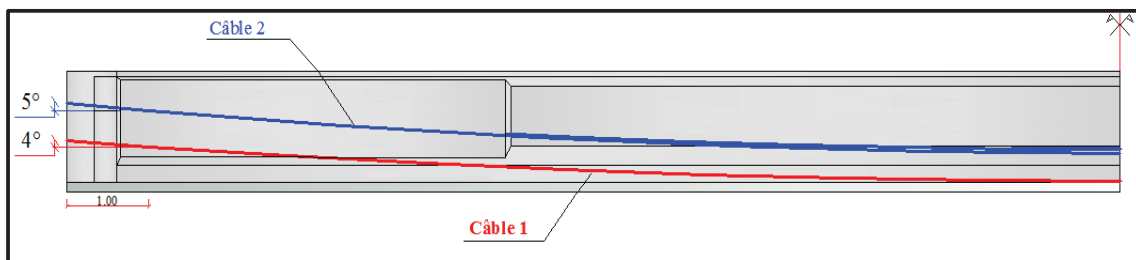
Schéma du tracé des câbles sur demi-poutre
